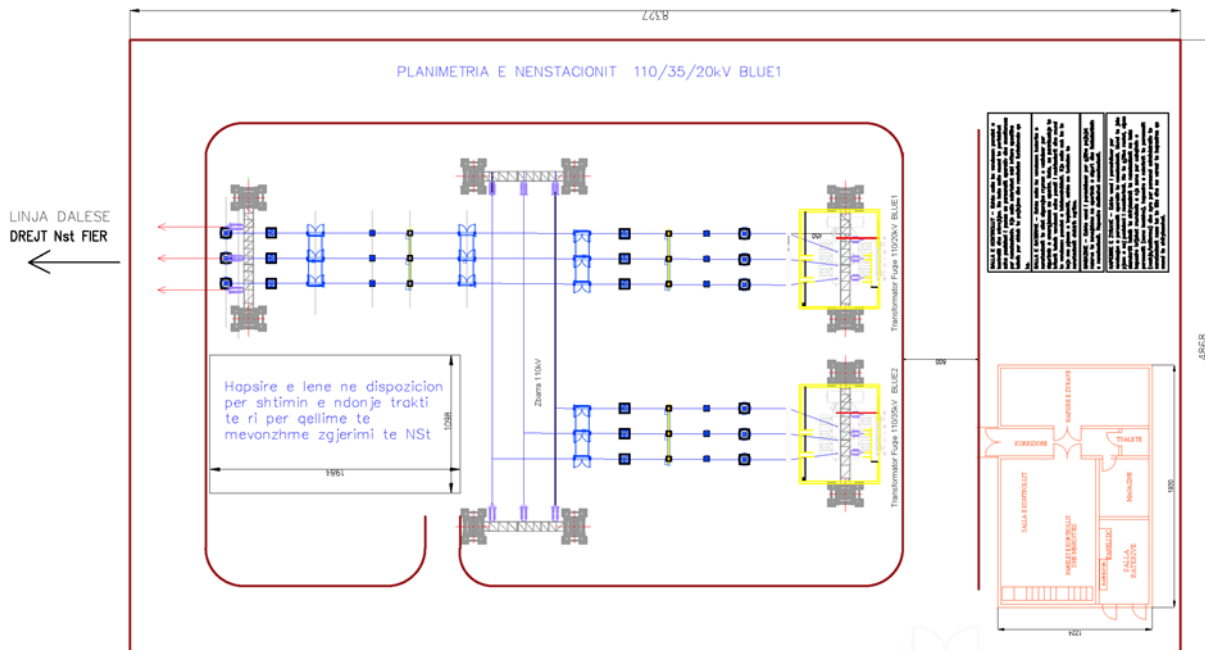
Planimetria e Nënstacionit 110/35/20 kV
